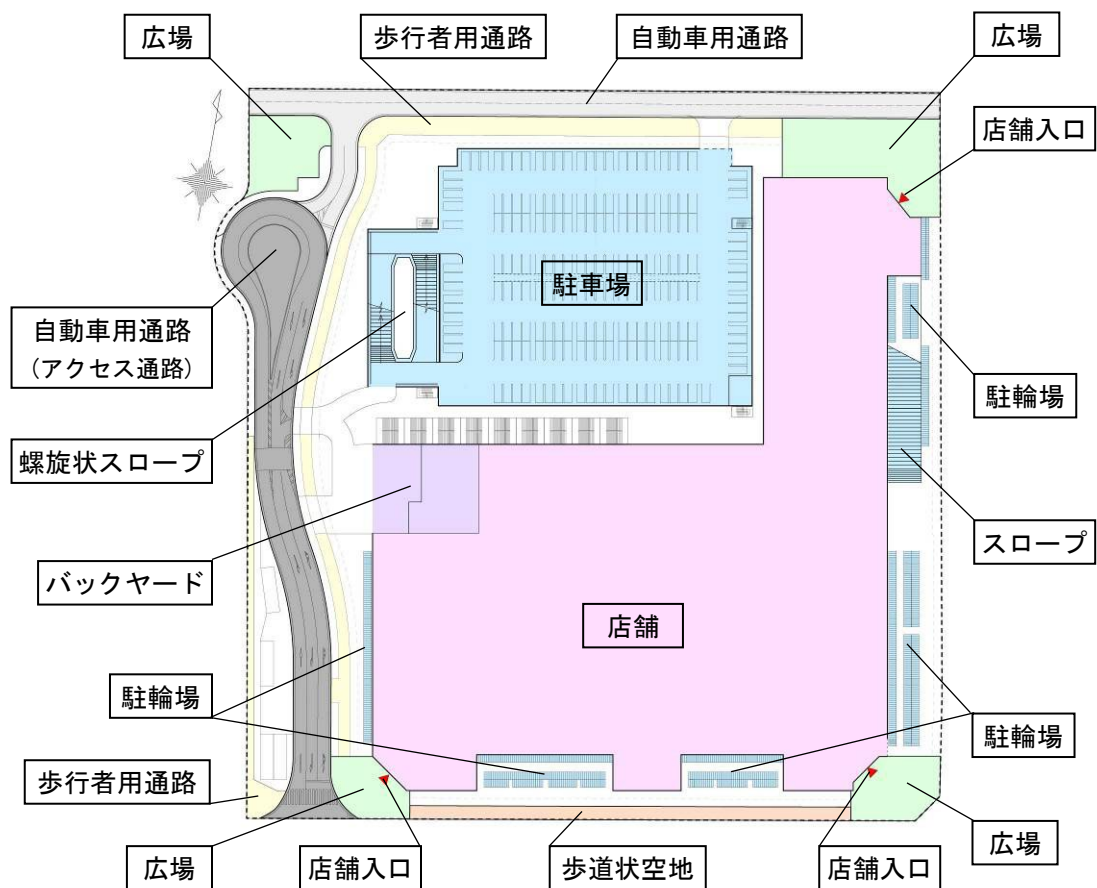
(1) 各階平面図(商業棟 1 階, 駐車場棟 1 階)【評価書時】
